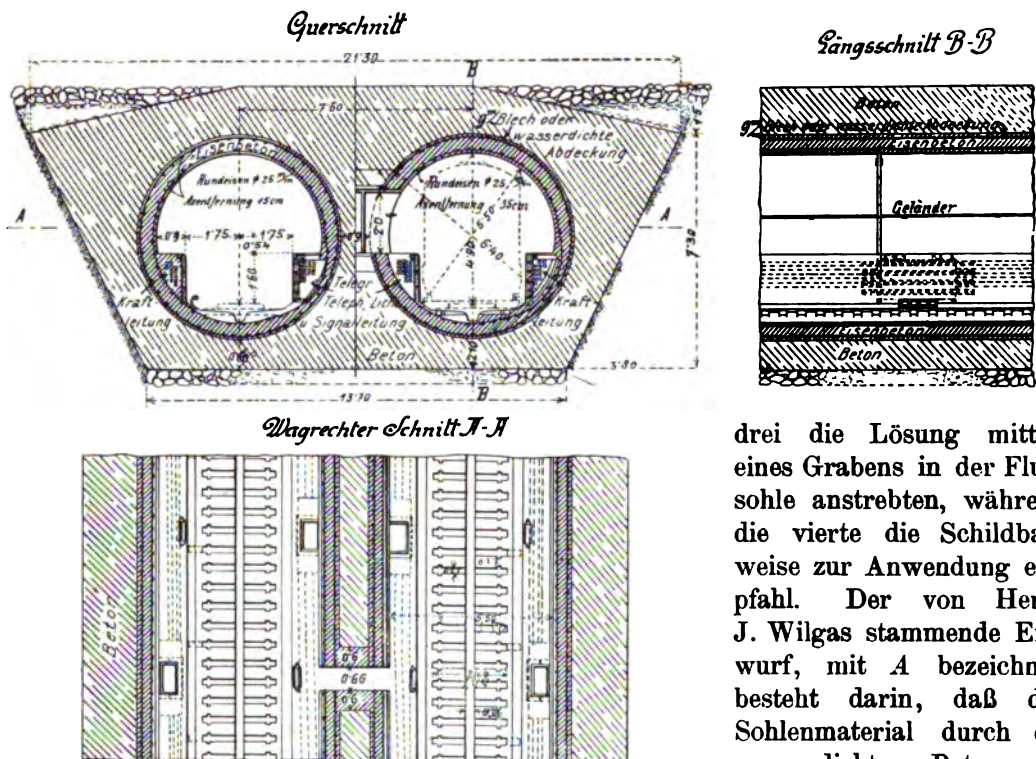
Querschnitt, Längsschnitt und Grundriß des Entwurfs A für den Detroit-Tunnel.
